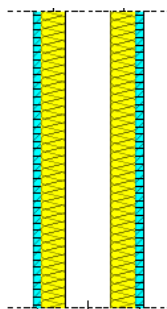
Pormenor da parede interior – Par\_Int\_6.
